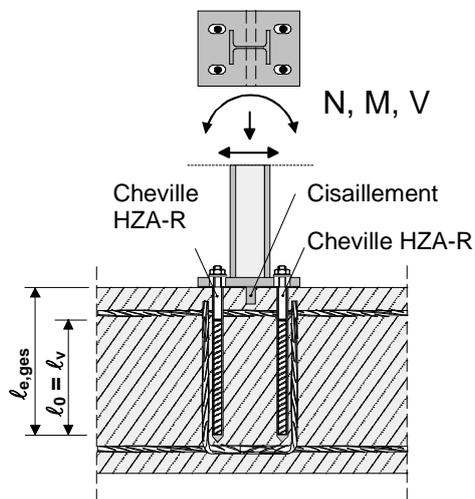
Recouvrement d'armatures pour la fixation de poteau
